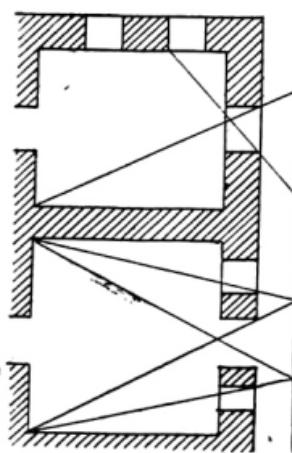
Привязка к причалке планов двух смежных, не связанных между собою помещений с проемами, выходящими на один фасад
